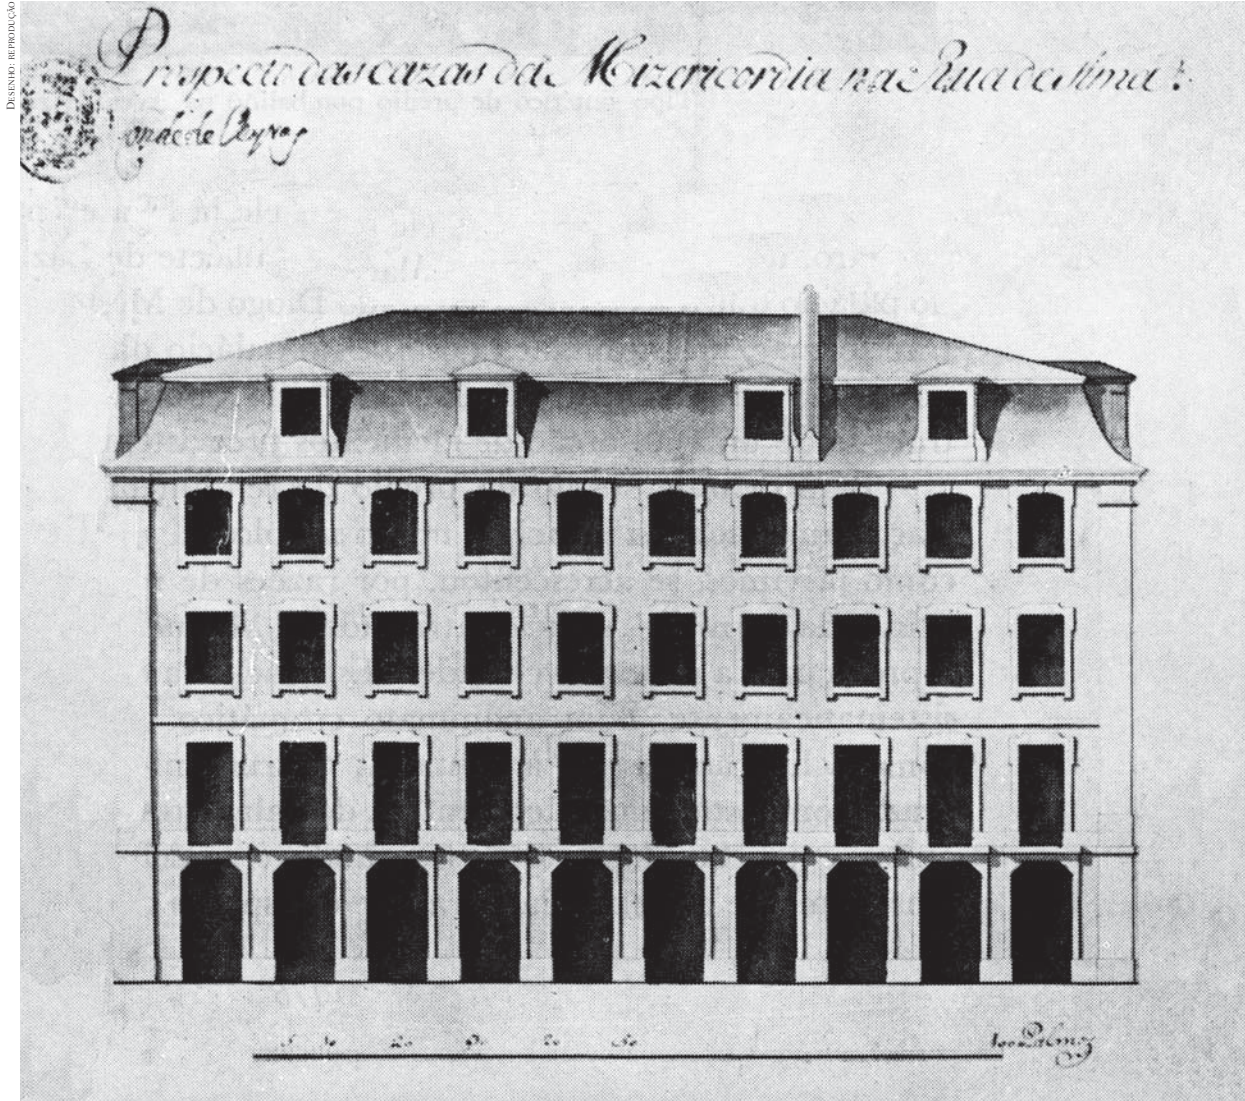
Fachada de tipo A com telhado “mardeliano”.
